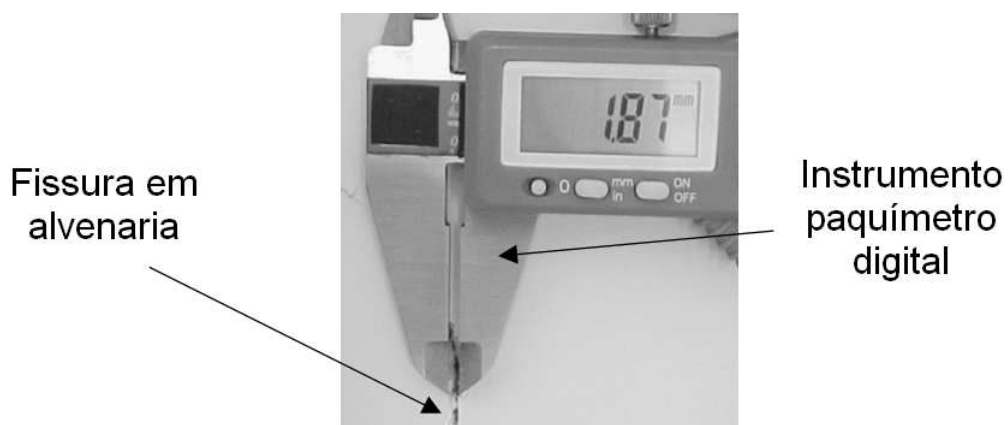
Instrumento paquímetro digital em medição convencional da abertura da fissura em alvenaria. A dimensão da fissura é indicada no visor após posicionamento do instrumento sobre a fissura na estrutura avariada.
